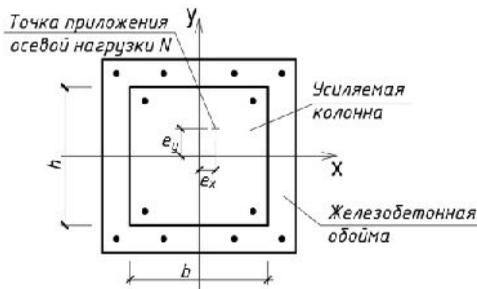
Расчетное сечение колонны, усиленной железобетонной обоймой
